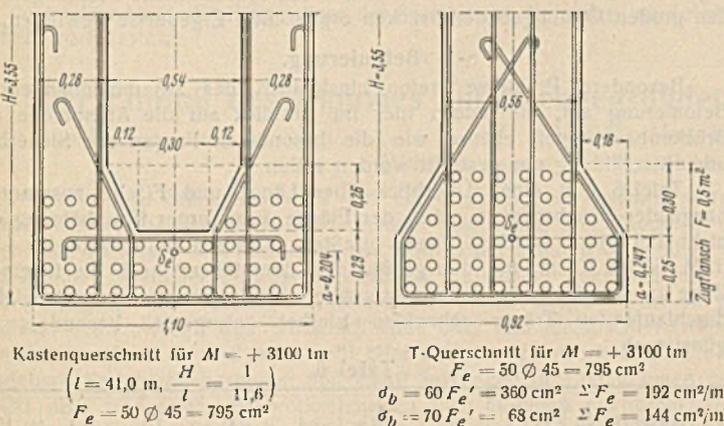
Hauptträger- und Bewehrungsquerschnitte.
